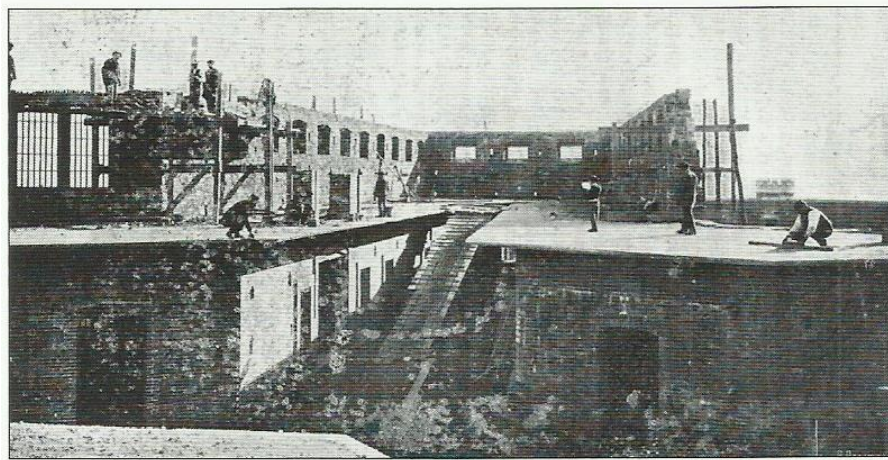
Obras de construcción de la Cárcel Modelo de Oviedo. Revista El cemento Armado No.12 año 1901
